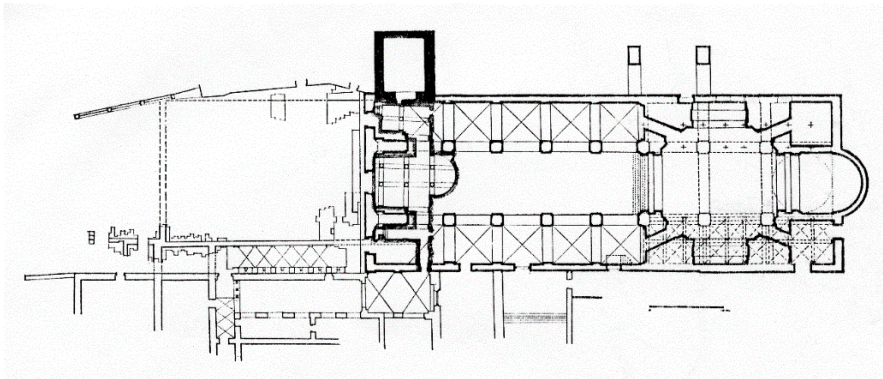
Assisi S. Rufino Grundriss nach Cardelli 1969
